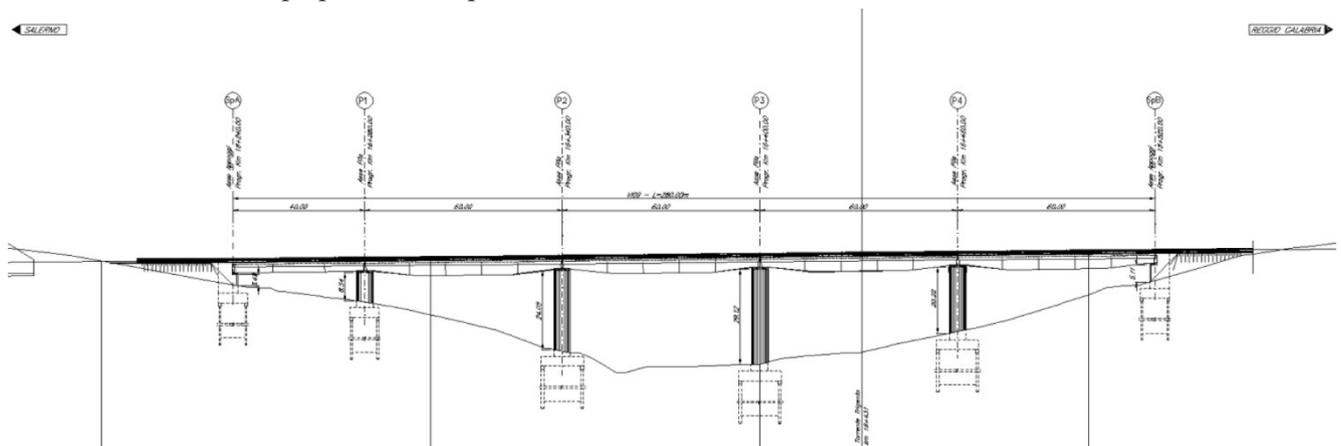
Prospetto viadotto di attraversamento del Torrente Trigento (VI09)
